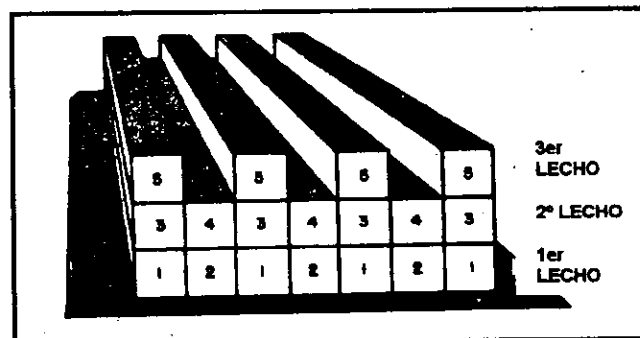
Secuencia de colado en pilotes prefabricados de concreto.
